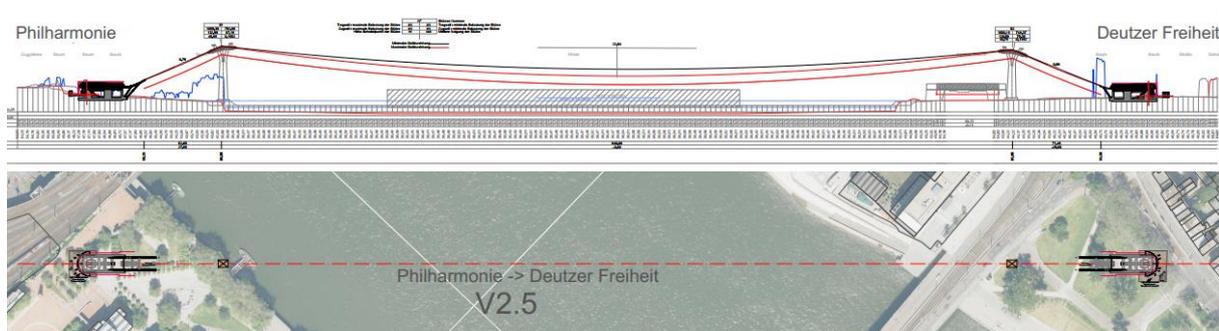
Längenschnitt, Lageplan Variante V2.5
